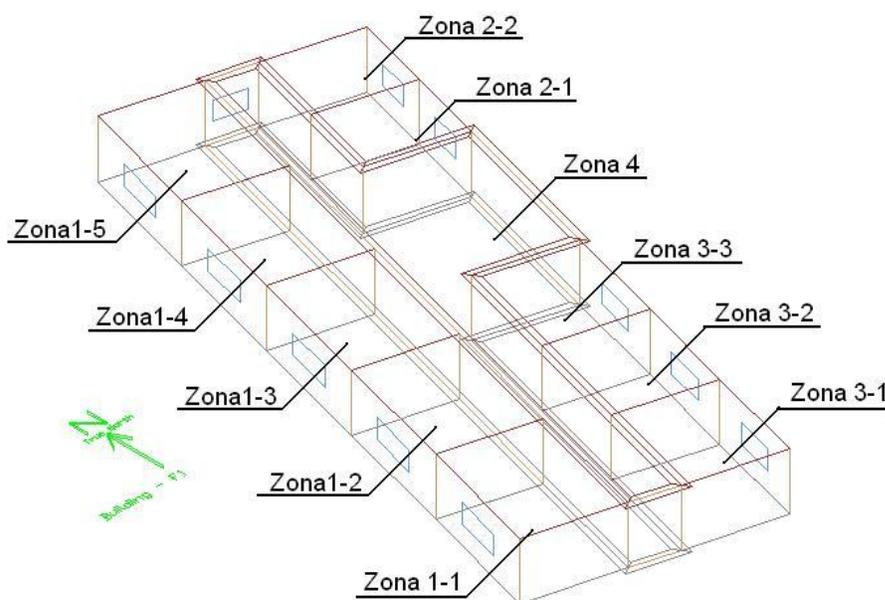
Novo zoneamento adotado no modelo do pavimento tipo
